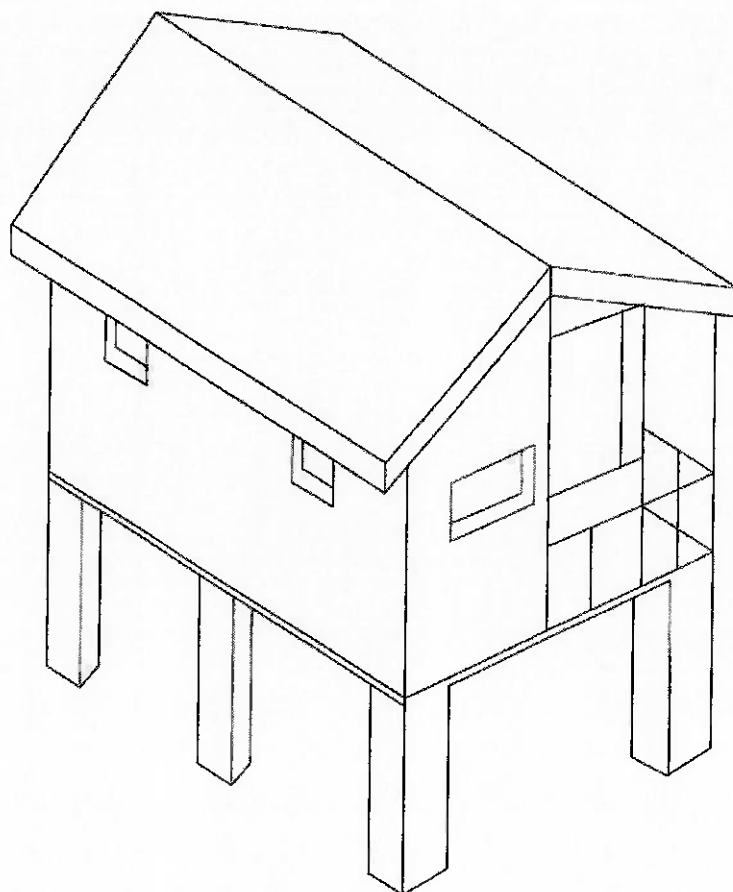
Casa com segundo pavimento (Lengen, 2008).
